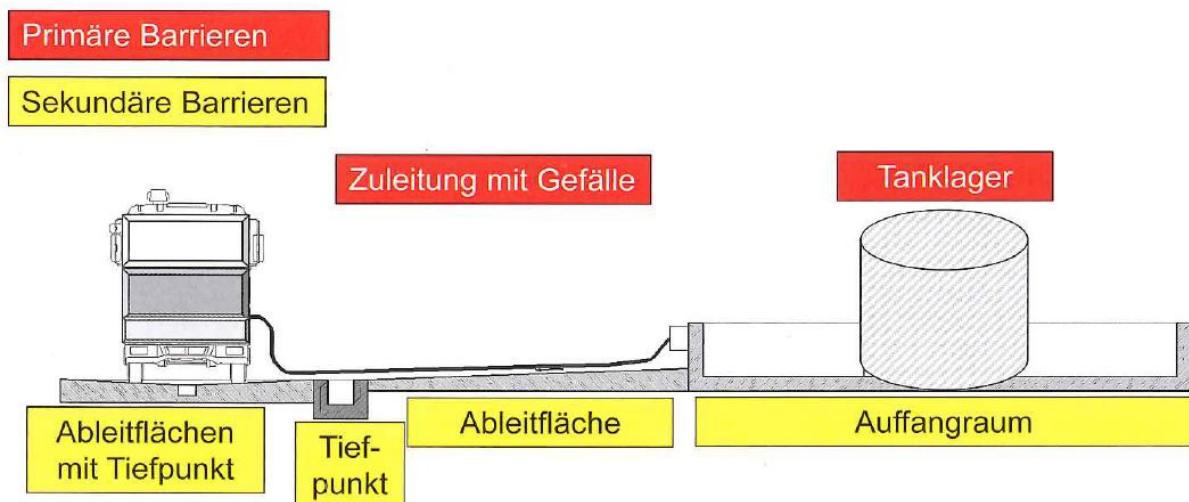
Kategorisierung von Bauteilen bei flüssigkeitsundurchlässigen Konstruktionen [Tagungsband Beton-Seminare 2016, Beton Marketing Nord]
